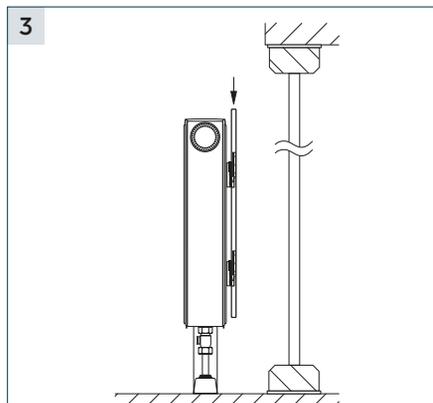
Plan-Strahlungsschirm in der Baulänge ausrichten, über den Z-Bügeln positionieren und nach unten drücken.
